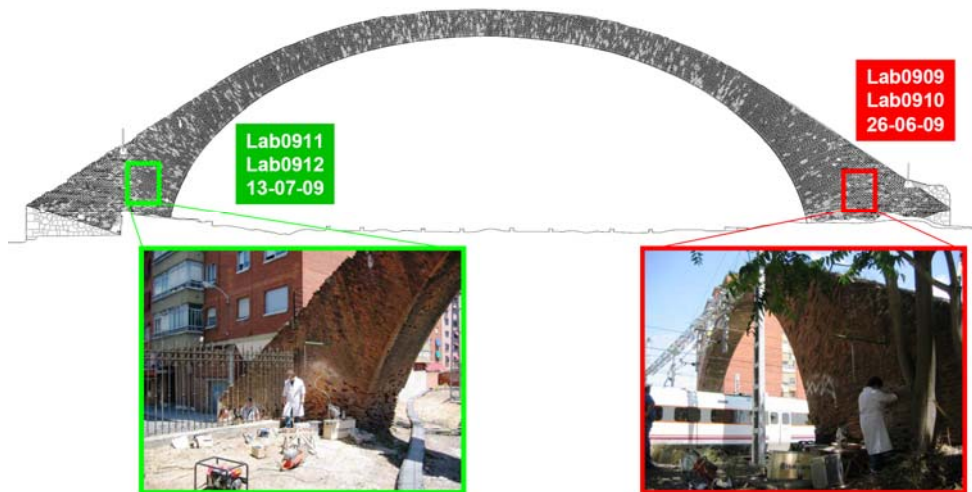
Localización de los ensayos de gato plano (alzado Oeste)
